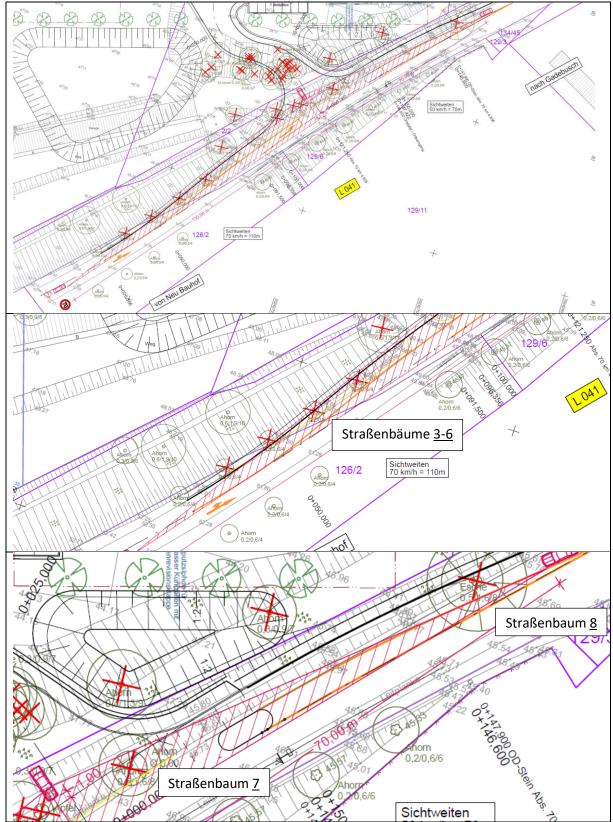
Straßenbäume Rodung, Quelle Auszug Lageplan Sichtweiten iBl Schwerin 06/22
